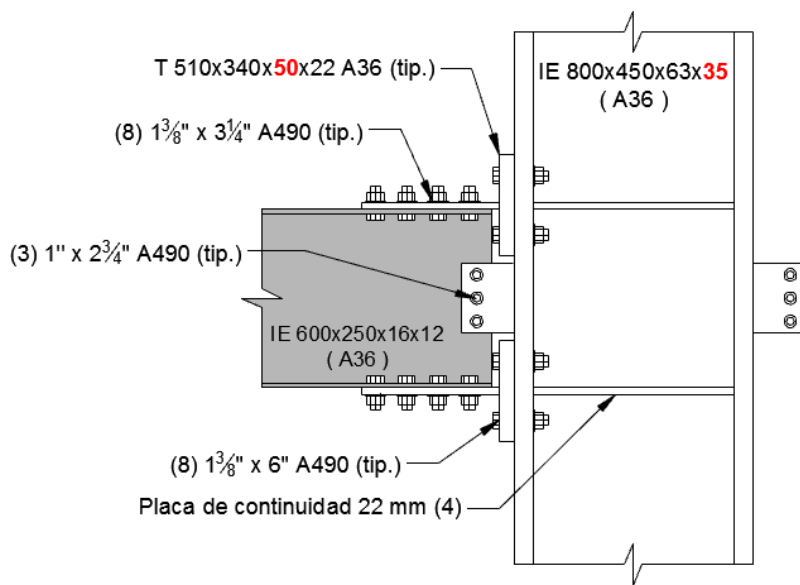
Detalle de conexión SE-02 (DBT1). Fuente: Salas (2016)
